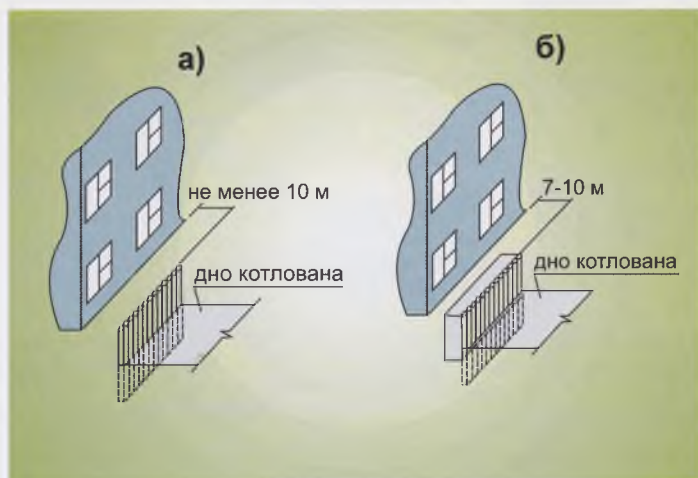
Способы строительства котлованов с использованием ограждающих конструкций из буресекующих свай: а) - на расстоянии не менее 10 м от фундаментов зданий - стена из буресекующих свай; б) - на расстоянии до 10 м от фундаментов зданий - стена из буресекующих свай, которая возводится после устройства грунтоцементного массива
